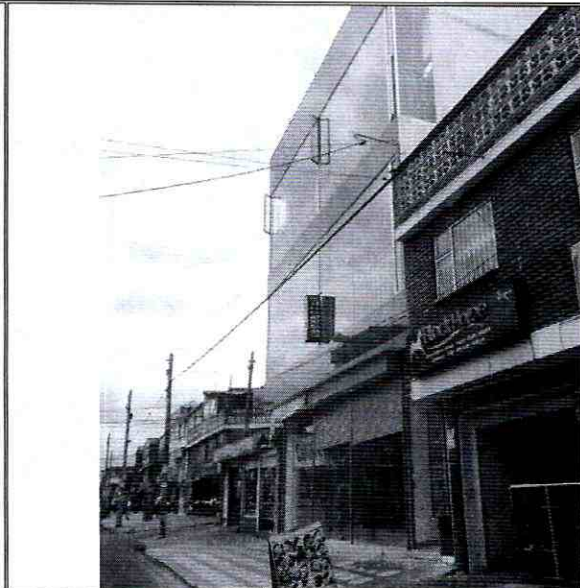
y 10. Presencia de fisuras y grietas en muros de la vivienda de la Carrera 77A No. 68A – 12.
